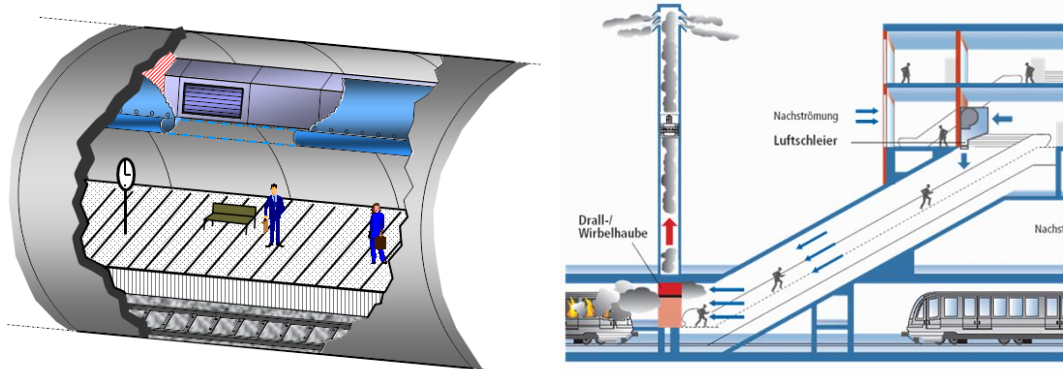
Prinzipdarstellungen: Begrenzung der Rauchausbreitung innerhalb der von einem Brand betroffenen Ebene (links); Verhinderung der geschossübergreifenden Rauchausbreitung (rechts)
